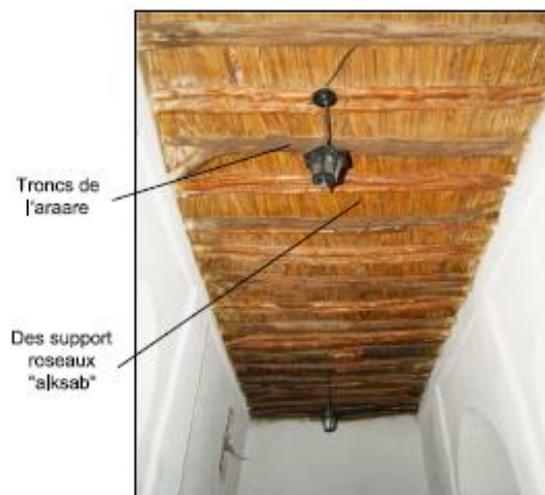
Planchers du ksar (Auteur, 2015).
